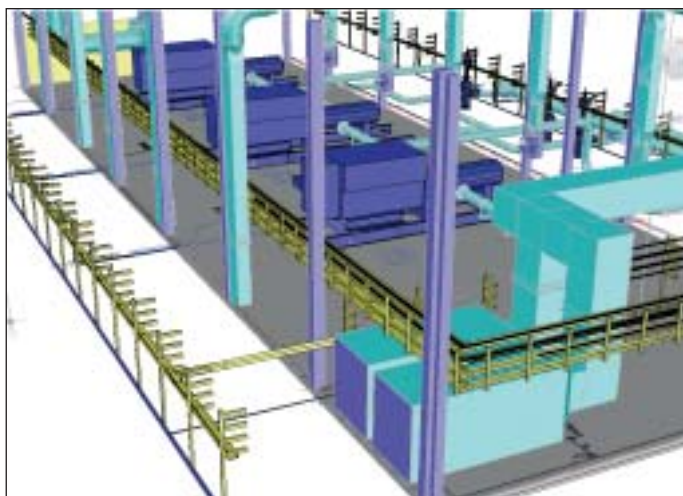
Кабельные конструкции снаружи и внутри помещения
